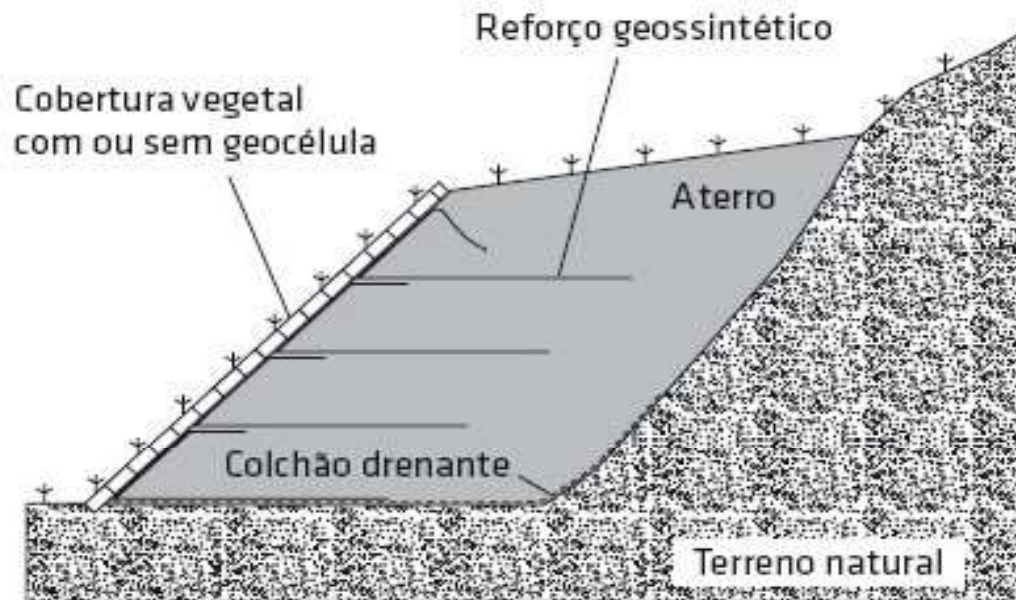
Seção típica Estrutura de solo reforçado com cobertura vegetal na face (Palmeira, 2018).
